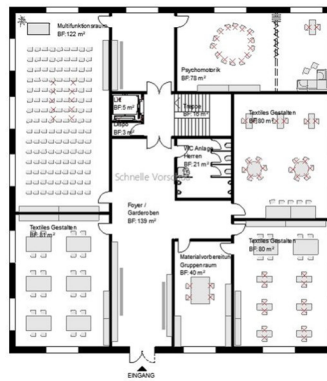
Disposition 01 | Grundriss 1. Obergeschoss
